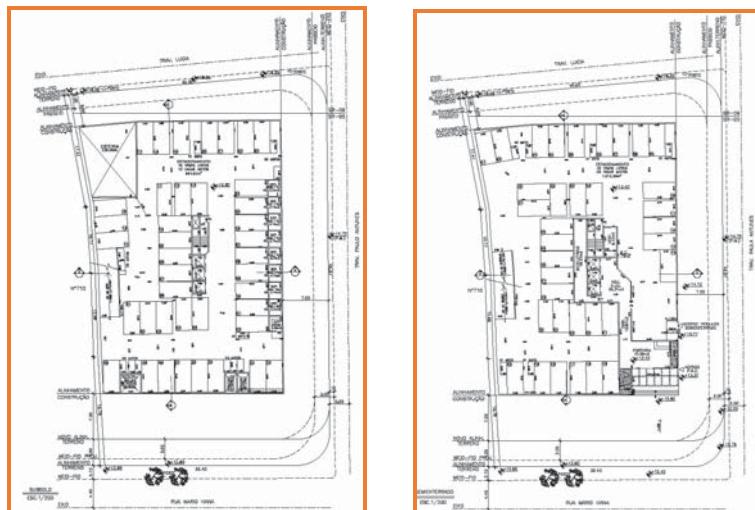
Subsolo e Semienterrado - Fonte: Projeto Legal
